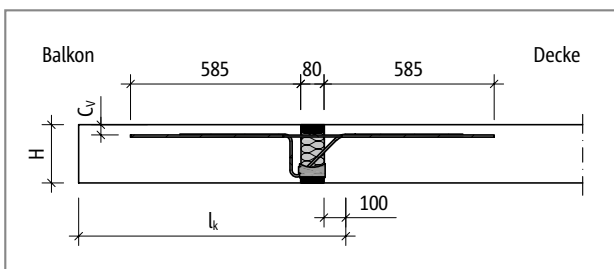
Schöck Isokorb® T Typ KL-M1 bis M7: Statisches System
